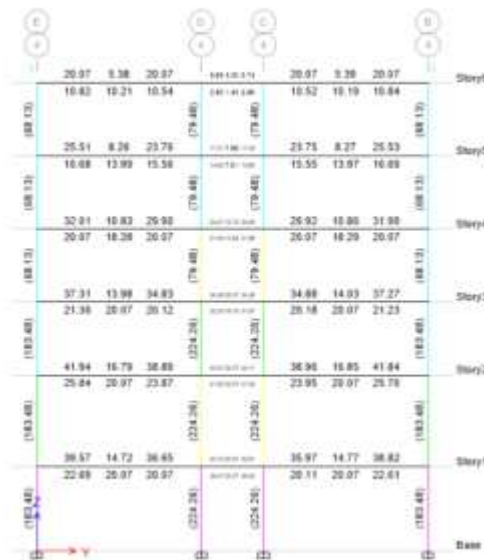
REFUERZO LONGITUDINAL EJE 3
